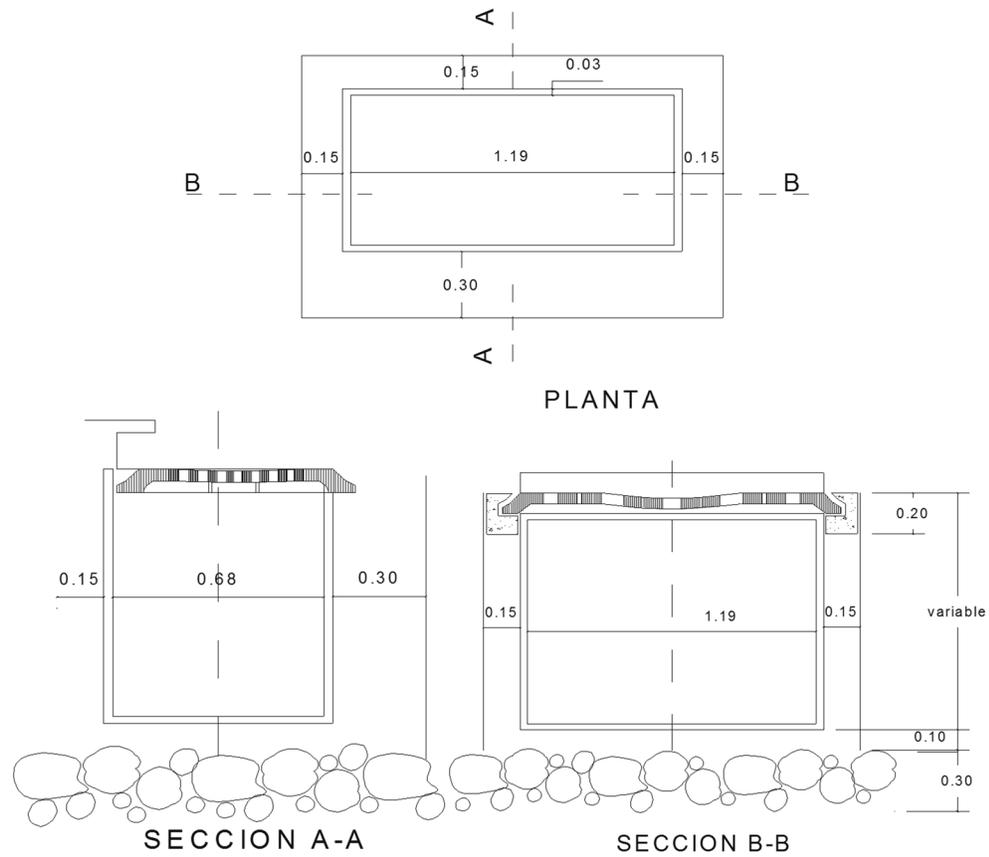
Detalle de caja tragante con parrilla de hierro fundido.
